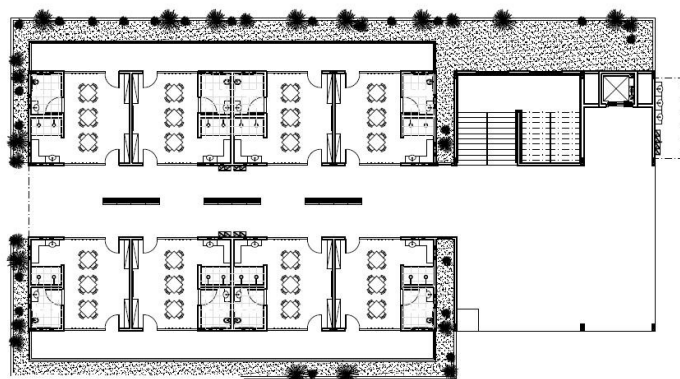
Planta Baixa – Bloco do Ensino I – Pav. Térreo.
